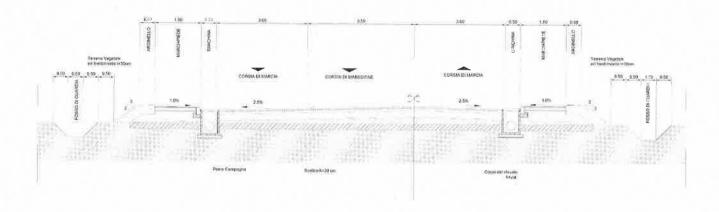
Sezione Tipo Rilevato tratto a 3 corsie compresa corsia di accumulo
